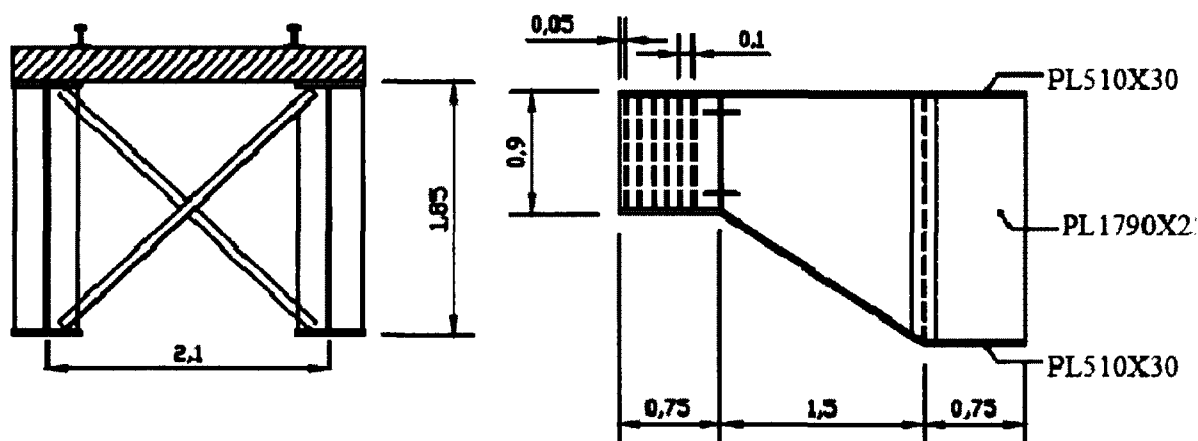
Pont bi-poutres - Section transversale et élévation - Section B-2
